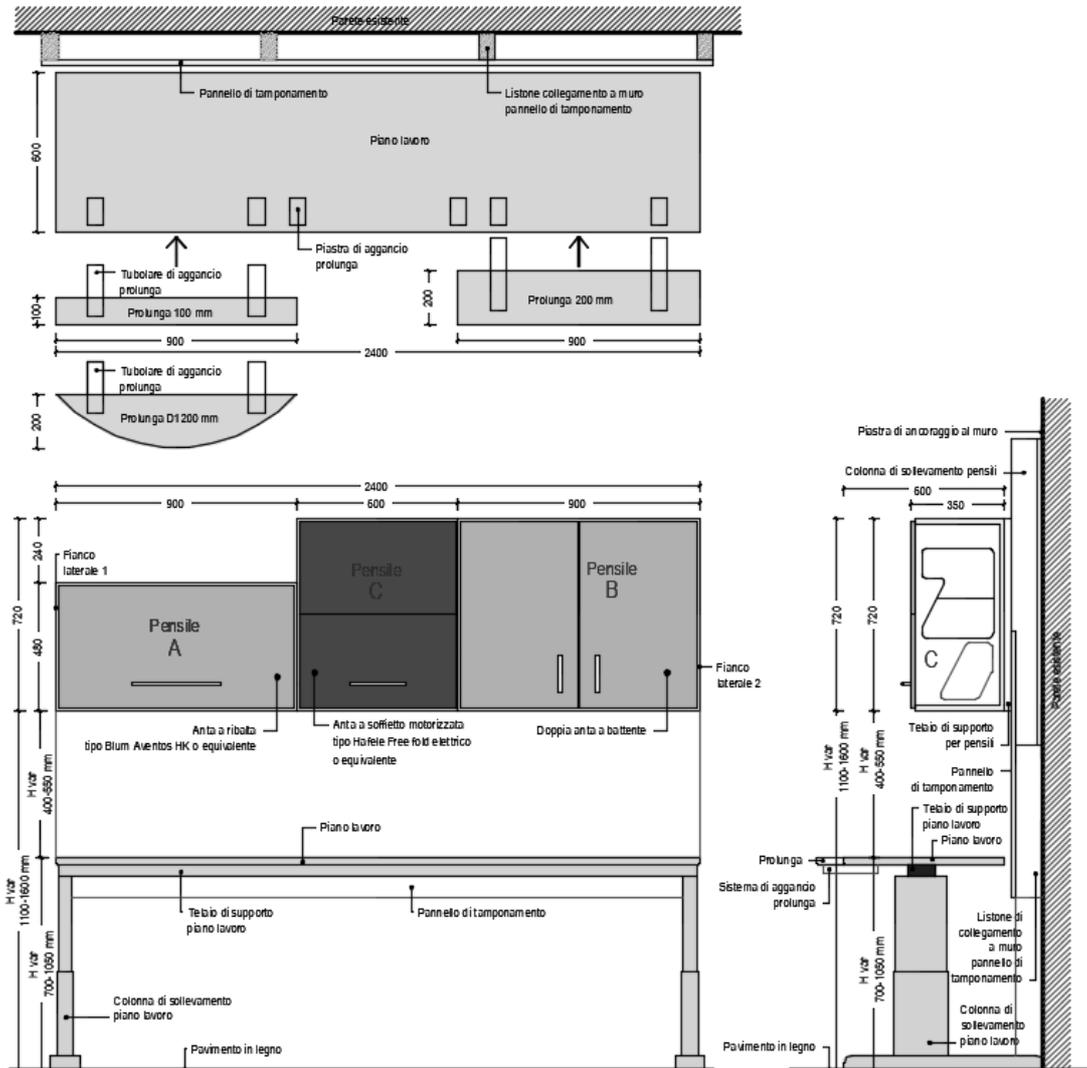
Pianta, prospetto frontale e sezione Blocco Ergonomia
